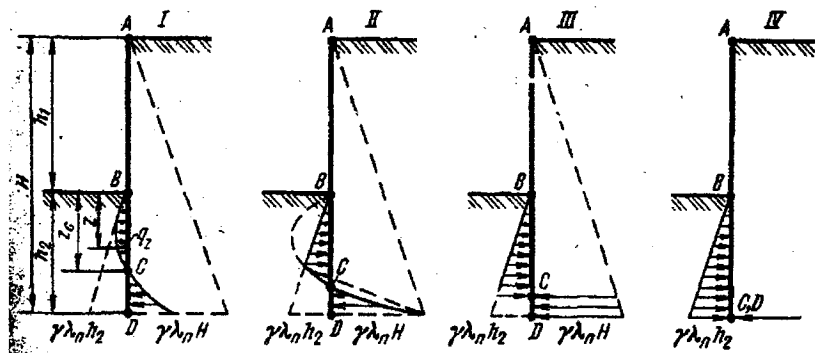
Схеми стадії I-IV опору основи тонкої стінки консольного типу
